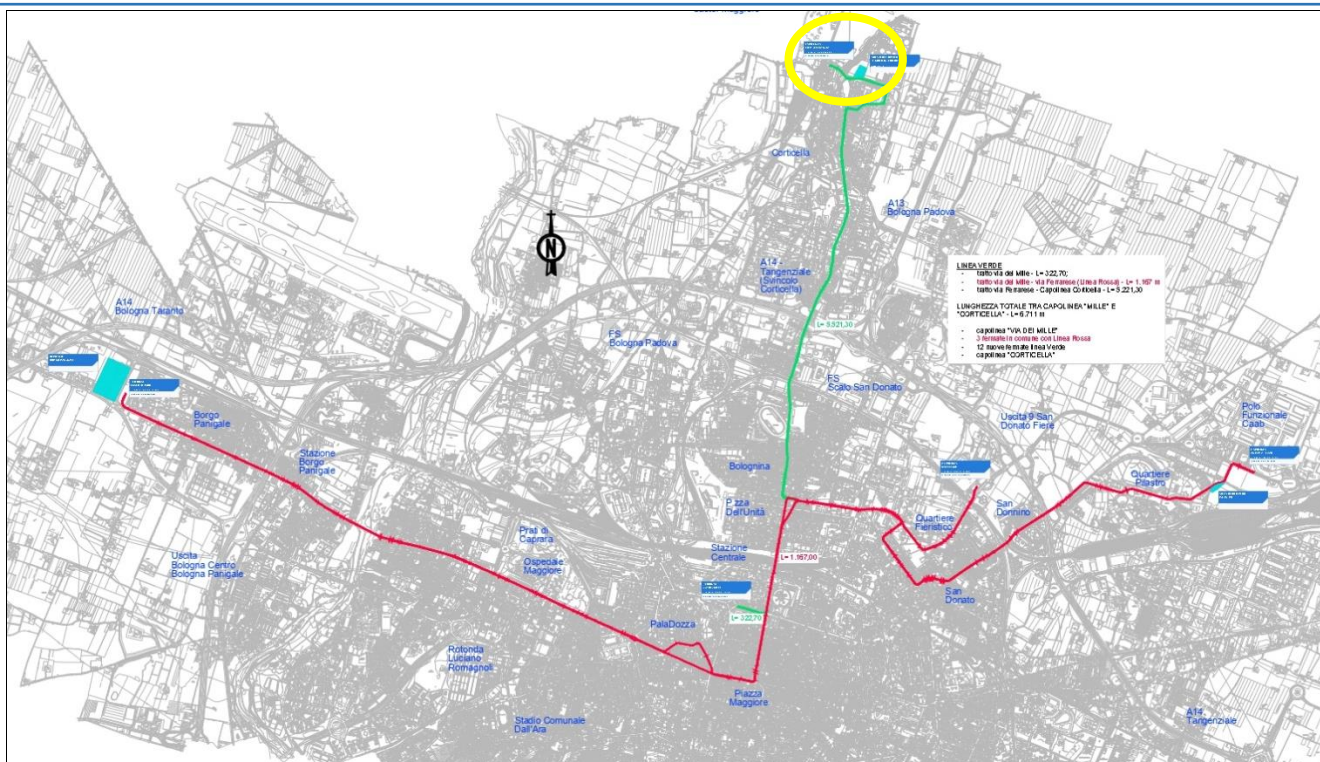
Planimetria generale Linea rossa + Tratta nord Linea Verde (in giallo l'area di interesse del presente studio)
